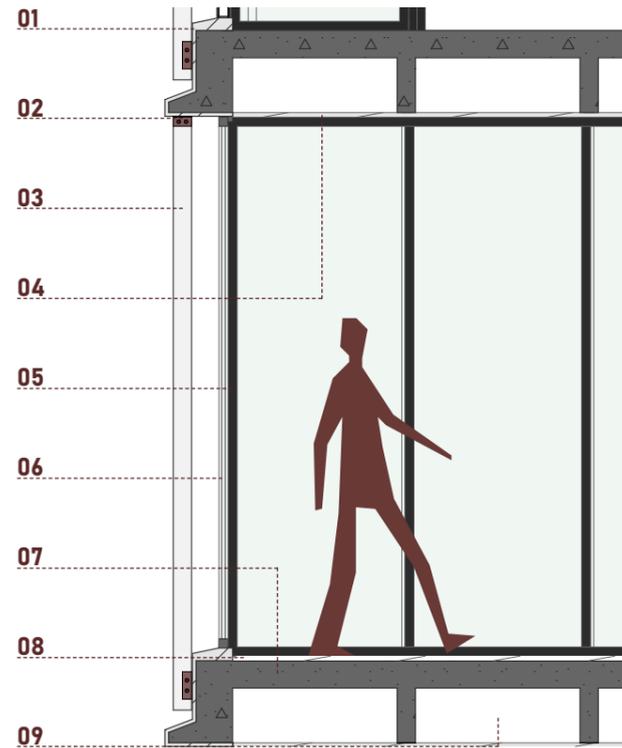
Sección constructiva - Anclaje de Brise Soleil. Fuente: Autoría propia.
